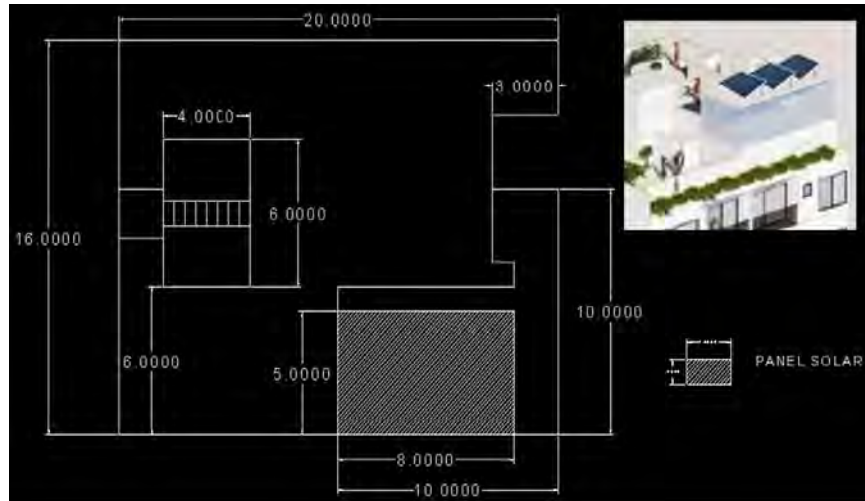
Plano de azotea y distribución de paneles solares en el techo del salón del gimnasio.
